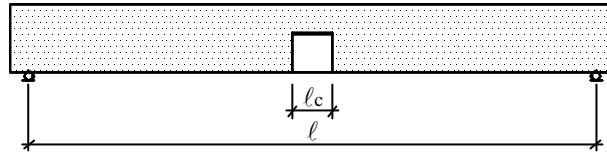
Idealização da viga fissurada segundo NAAMAN (1990)
